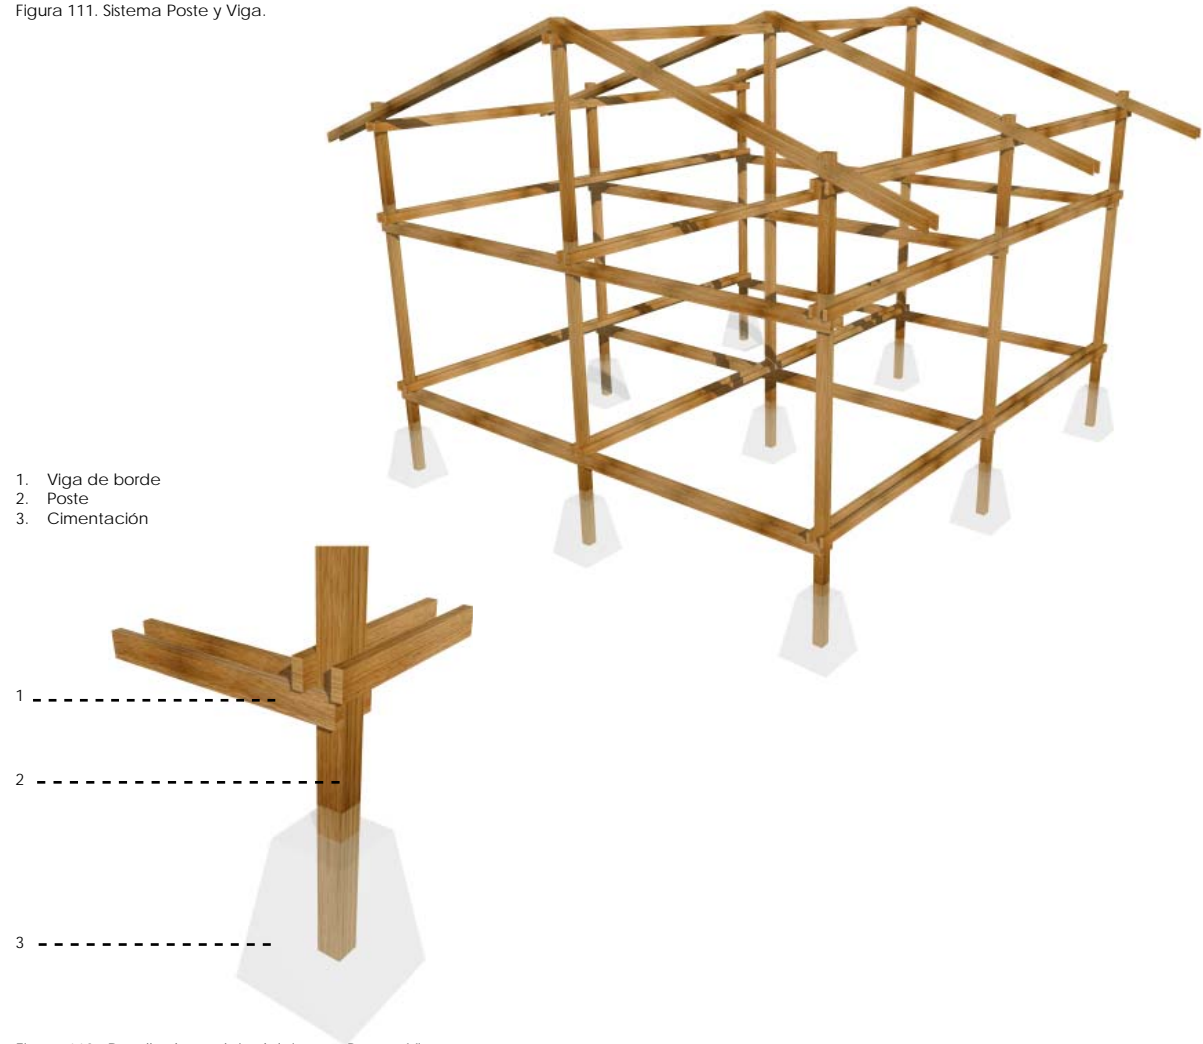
Detalle de anclaje del sistema Poste y Viga.
